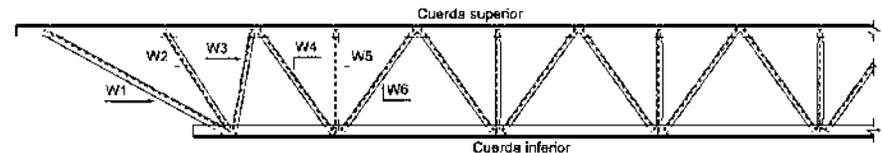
ESTRUCTURA JOIST FUENTE: <http://www.arquitecturaenacero.org/uso-y-aplicaciones-del-acero/soluciones-constructivas/steel-i-joist>
